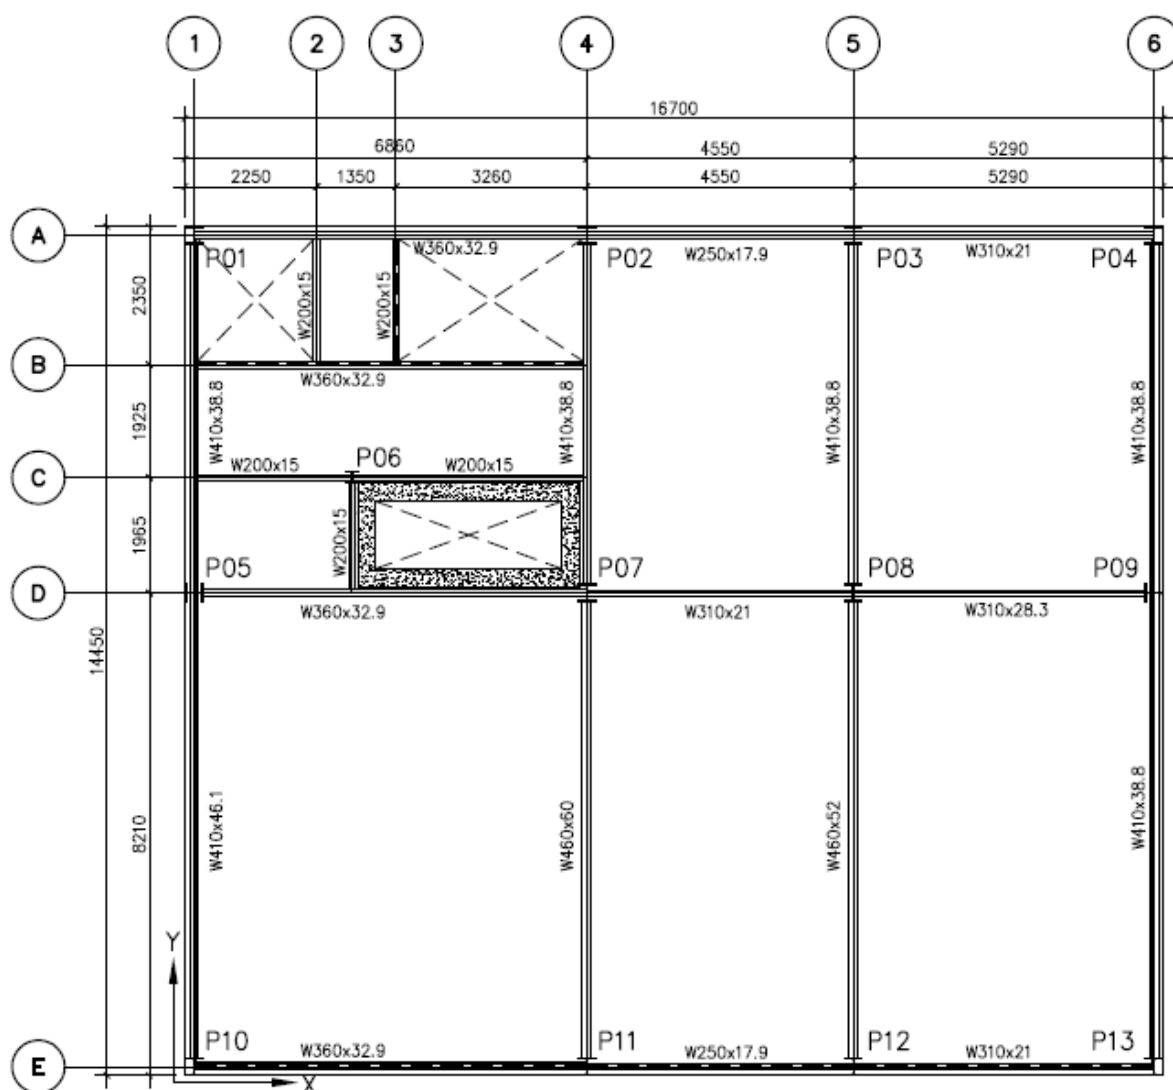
Planta Baixa do edifício analisado em aço com núcleo de concreto armado
